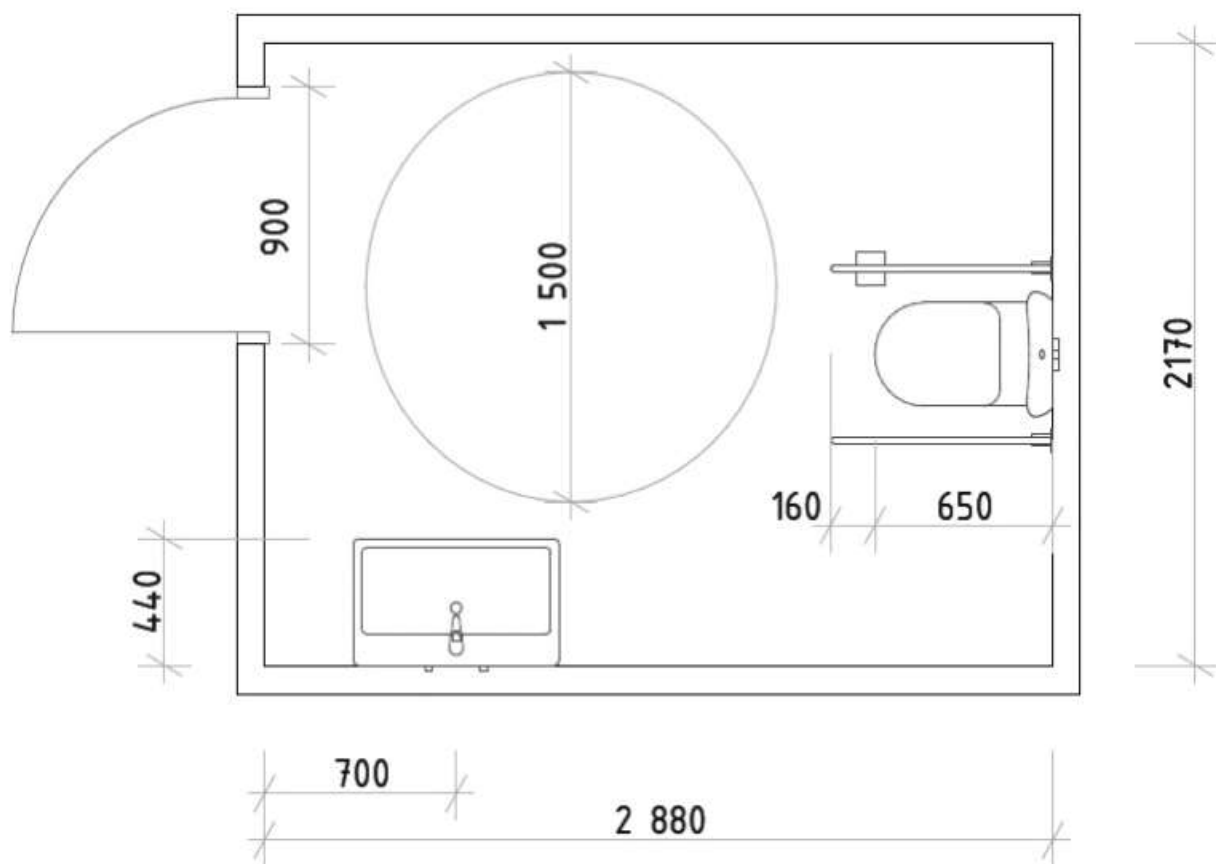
Планувальне рішення універсальної kabіни санвузла для МГН
